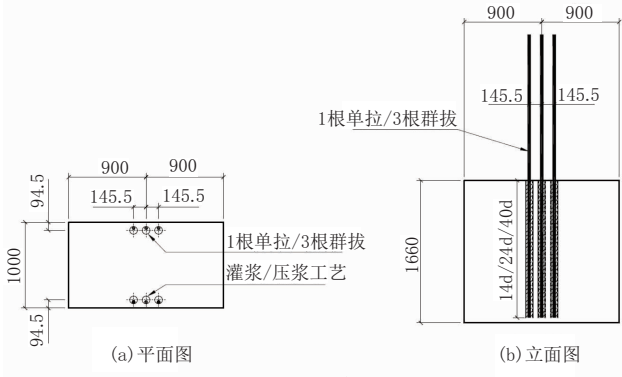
灌浆波纹钢管拉拔试件构造示意图(单位:mm)
